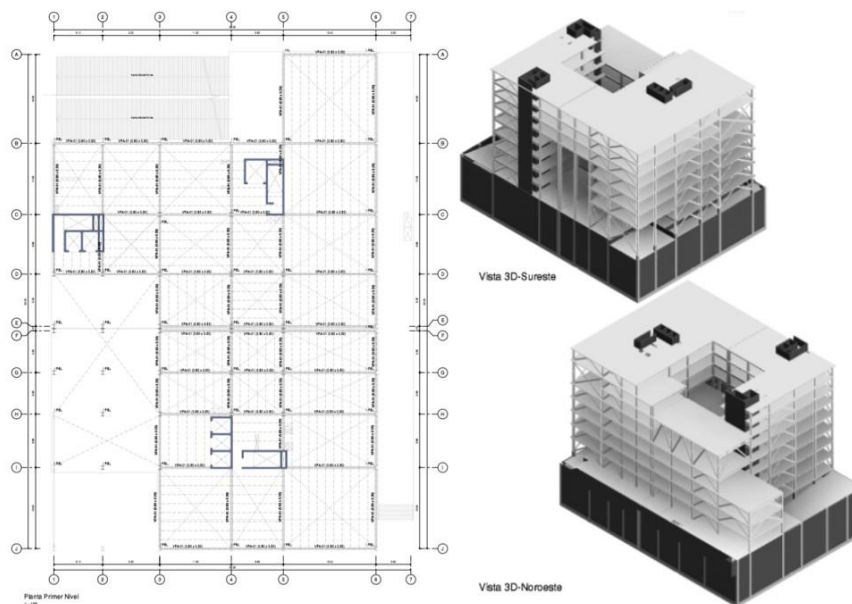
Vista planta del sexto nivel y vistas isométricas del edificio el cual emplea sistema mixto: concreto y acero del primer al octavo piso.
